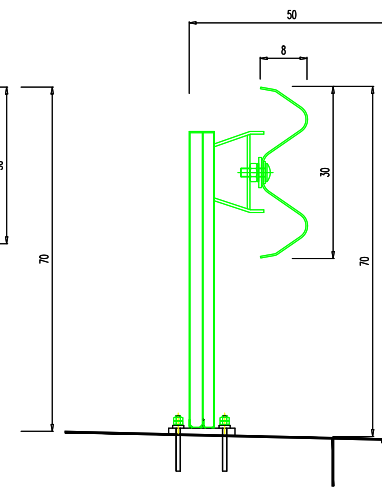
DETAIL LONGRINES DES BARRIERES EXTERIEURS
